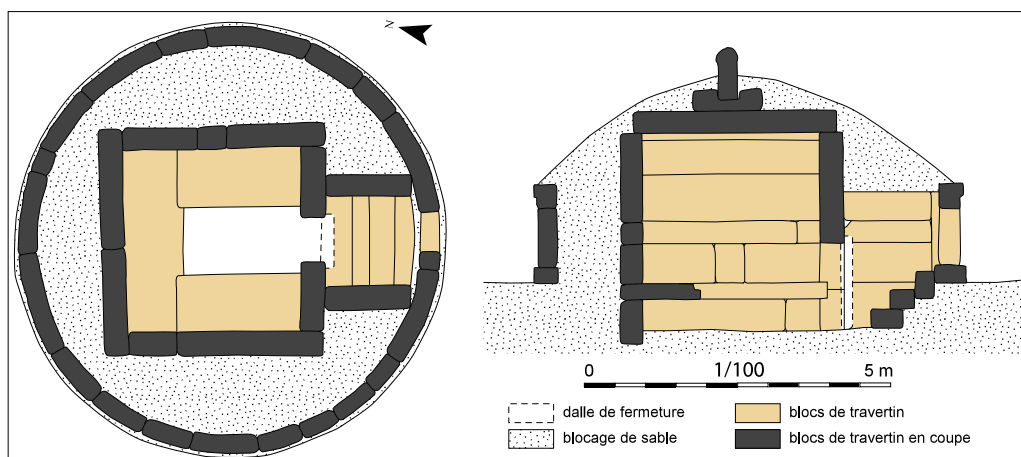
plan et coupe du tumulus 51, nécropole nord
